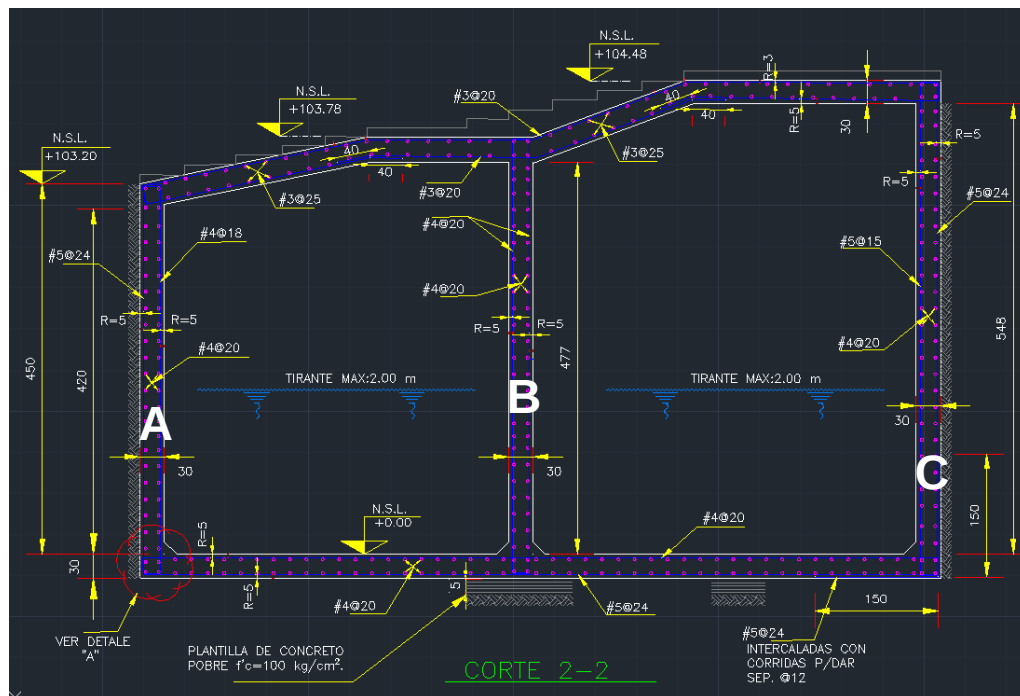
Corte 2-2 en el cual se muestra el armado de la losa, los muros y la losa tapa de la cisterna.
